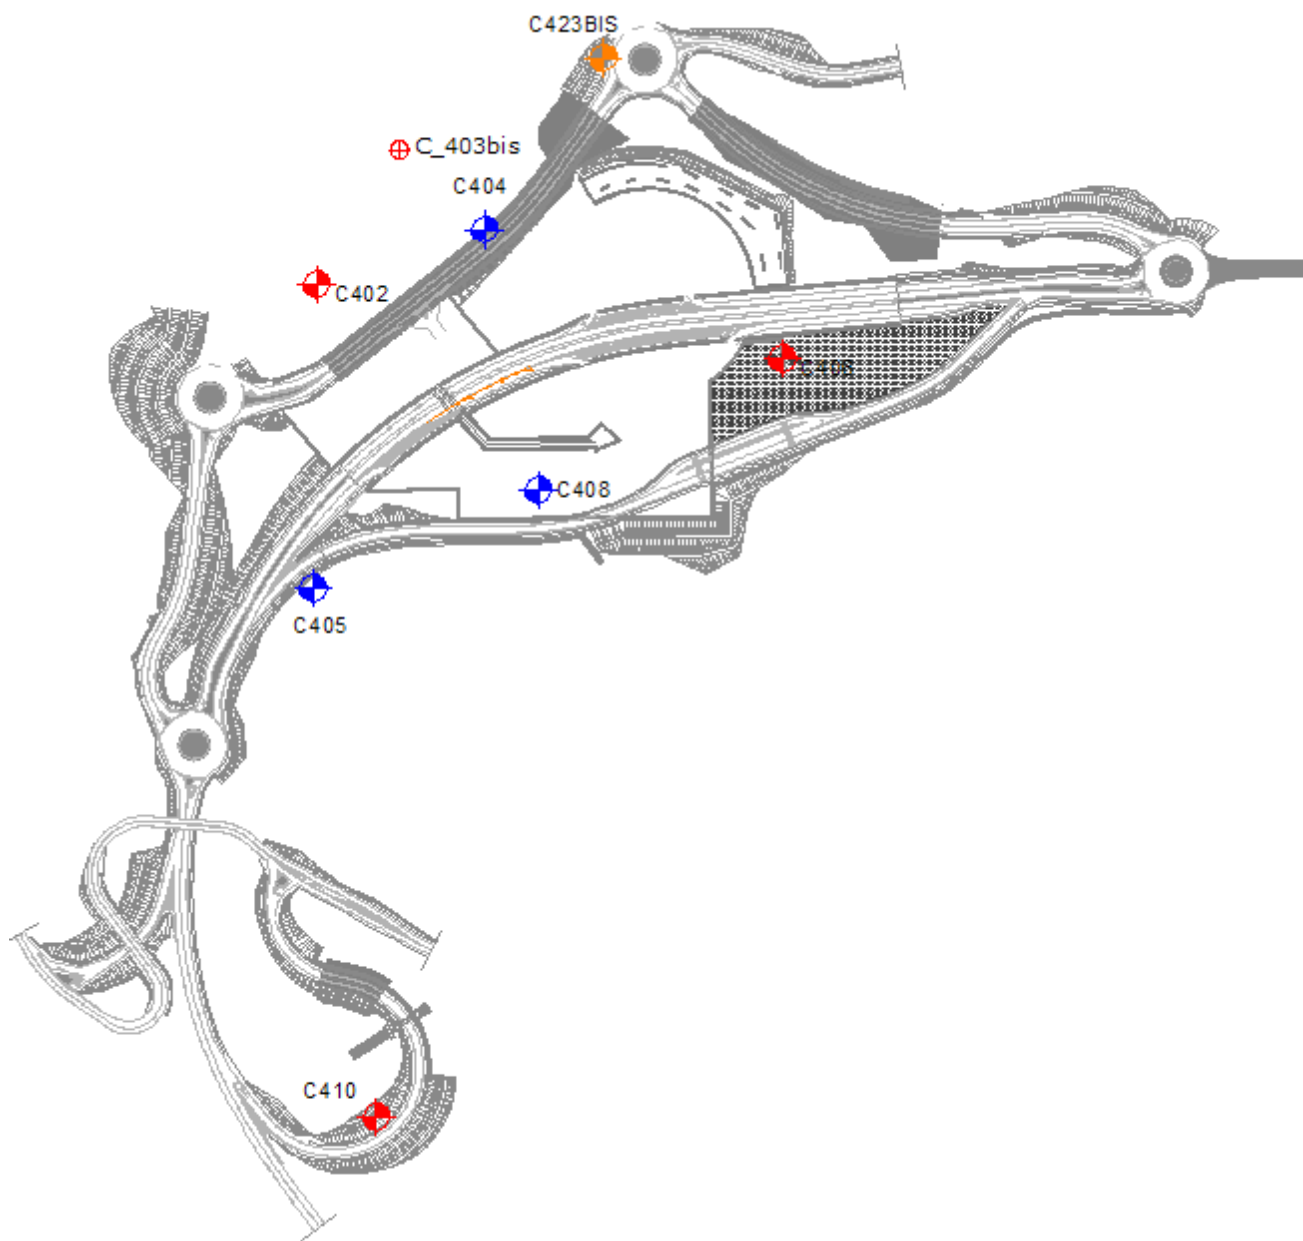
Stralcio planimetrico e ubicazione indagini
